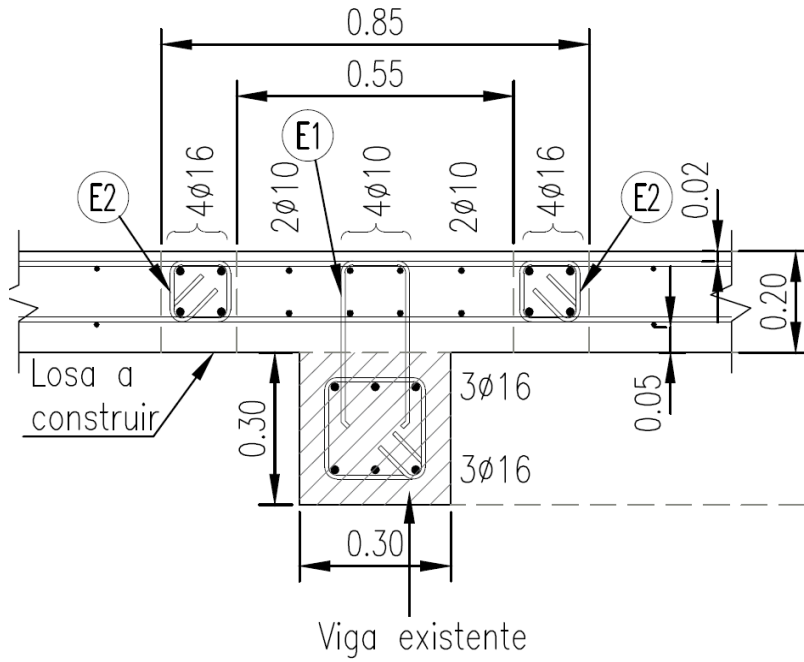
Ingeniería de detalle en sección transversal de refuerzo de vigas de fundación con ubicación de losa a nivel -9.40m. Refuerzo en vigas de 30cmx30cm en toda su longitud. Ver planos de detalle con cálculos incluidos.
